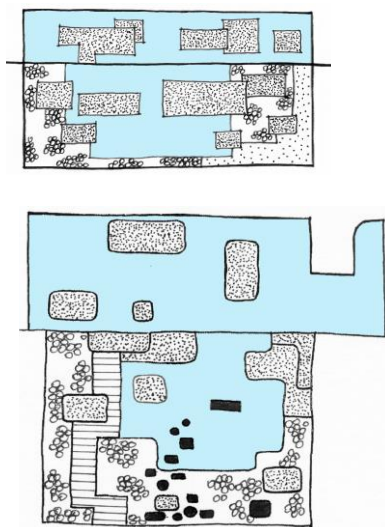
Trazados definidos en la primera y segunda versiones del jardín interno en la planta baja del MRE.
